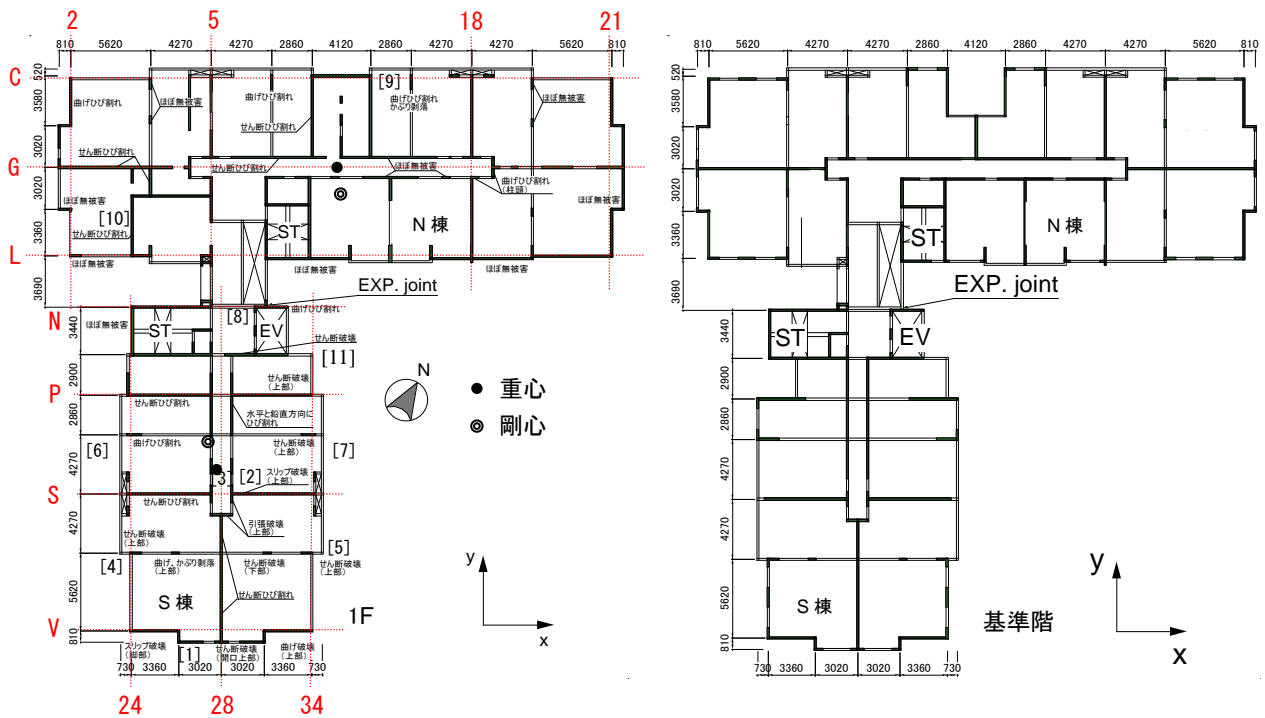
左:1階平面図・損傷詳細 右:基準階平面図
